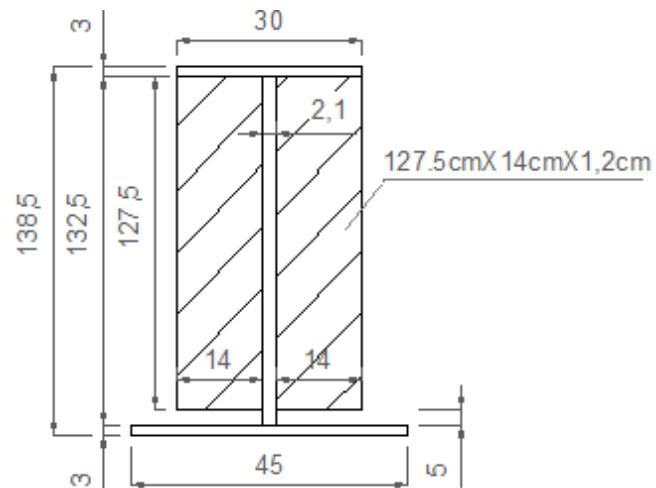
Rigidizadores transversales intermedios (Sección B y L)
